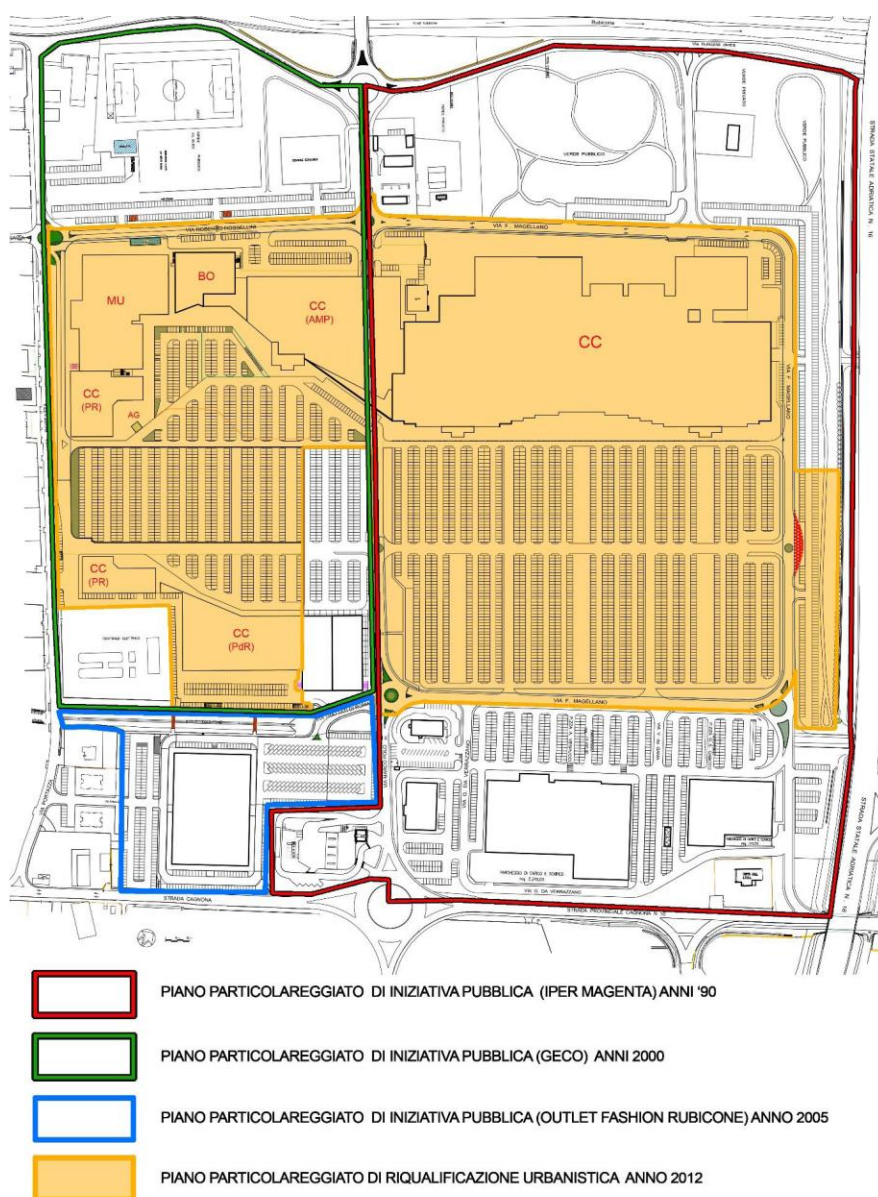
Planimetria del Polo Funzionale con individuazione dei Piani Particolareggiati eseguiti
